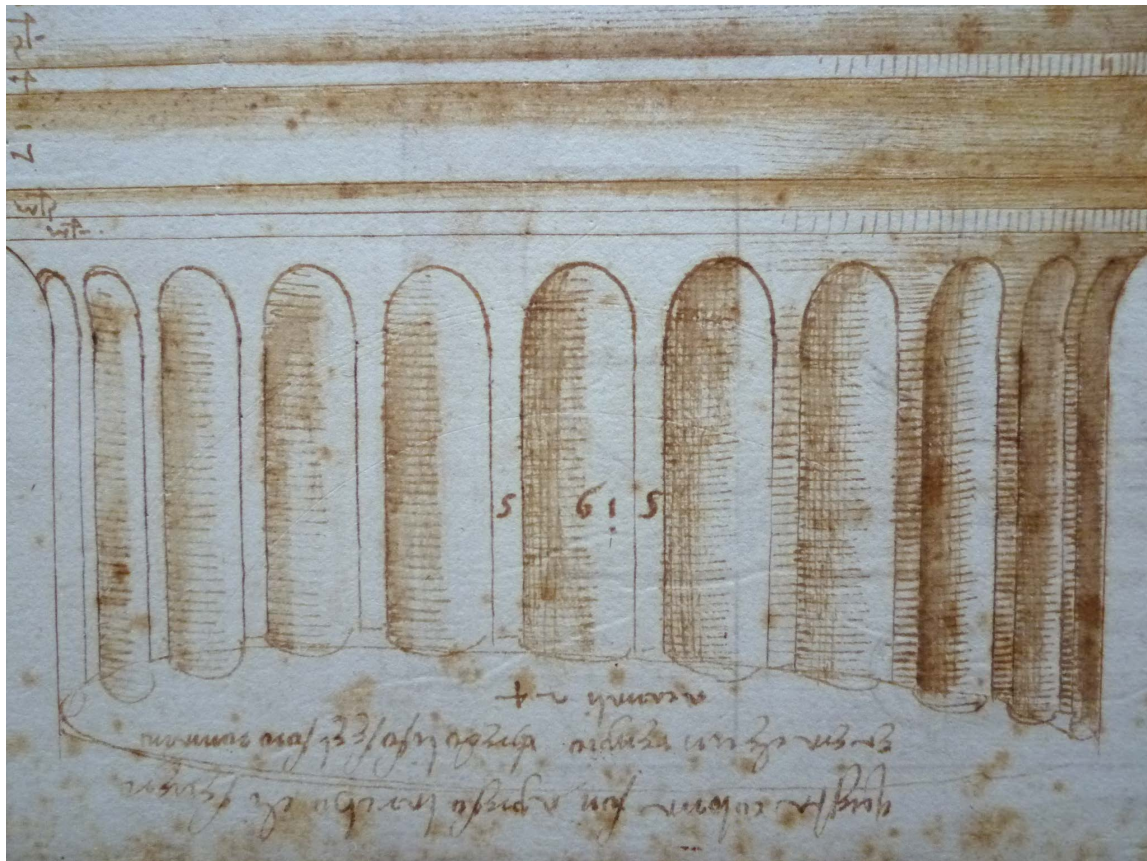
Säulendetail. Palladio MCV-D32v (Foto der Autorin).
